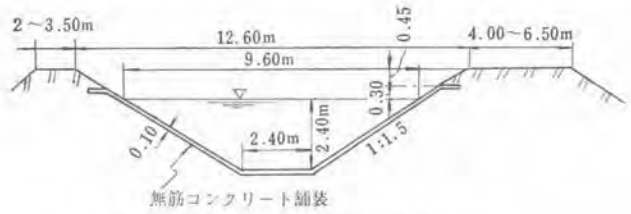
開水路標準断面図 (Q=14.3 m³/sec)
